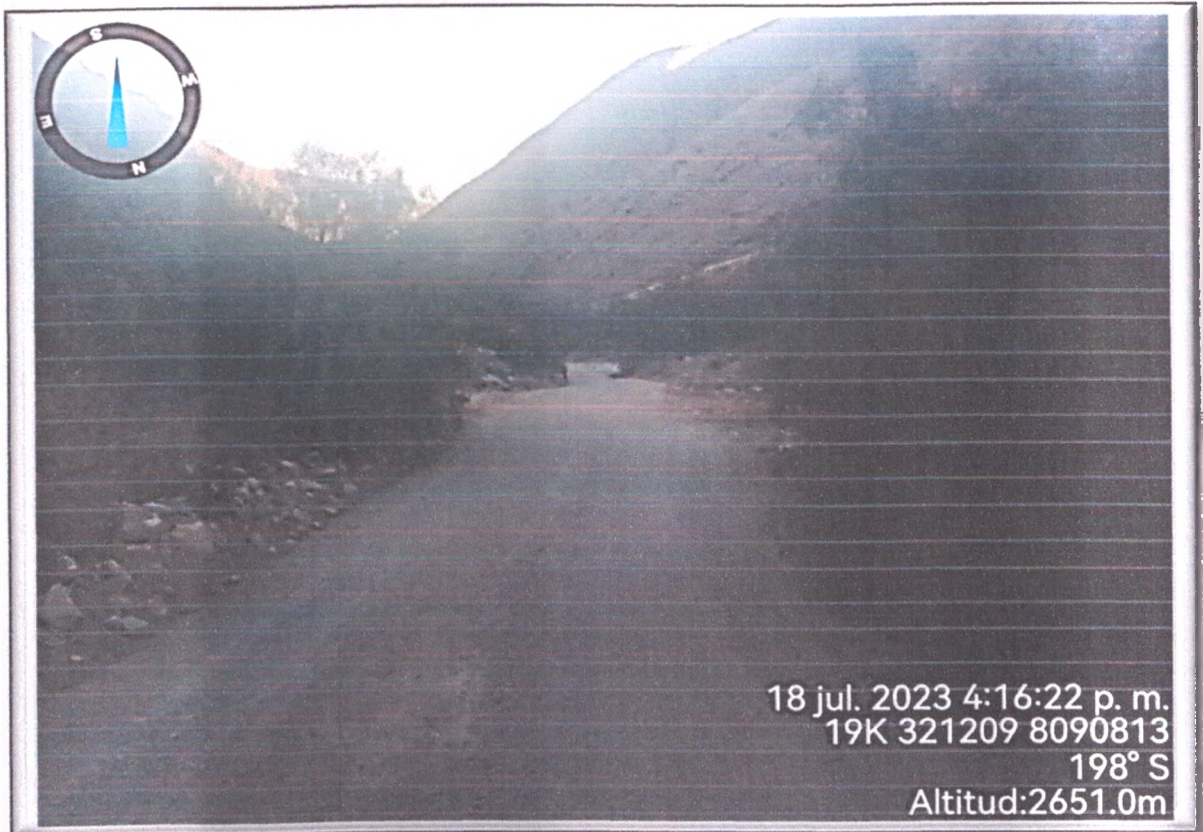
Plataforma de rodadura presenta ahuellamiento y desgaste por erosión, zona de plantas para roce, Km. 87+900
